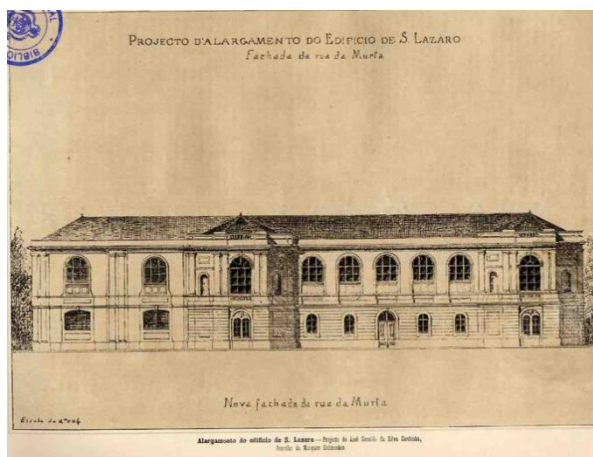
Alargamento do Edifício de S. Lázaro, fachada da rua da Murta Rua da Fabrica 66, Porto 1882¹⁹⁷.
